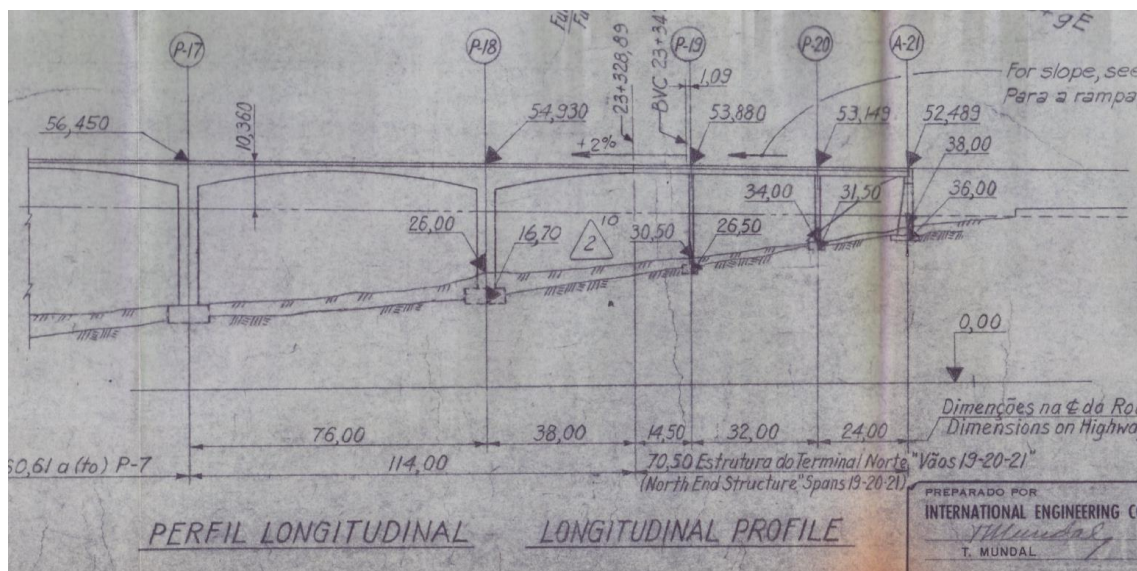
Perfil longitudinal do tabuleiro rodoviário (Peça desenhada nº C-003 As-Built 1962)
